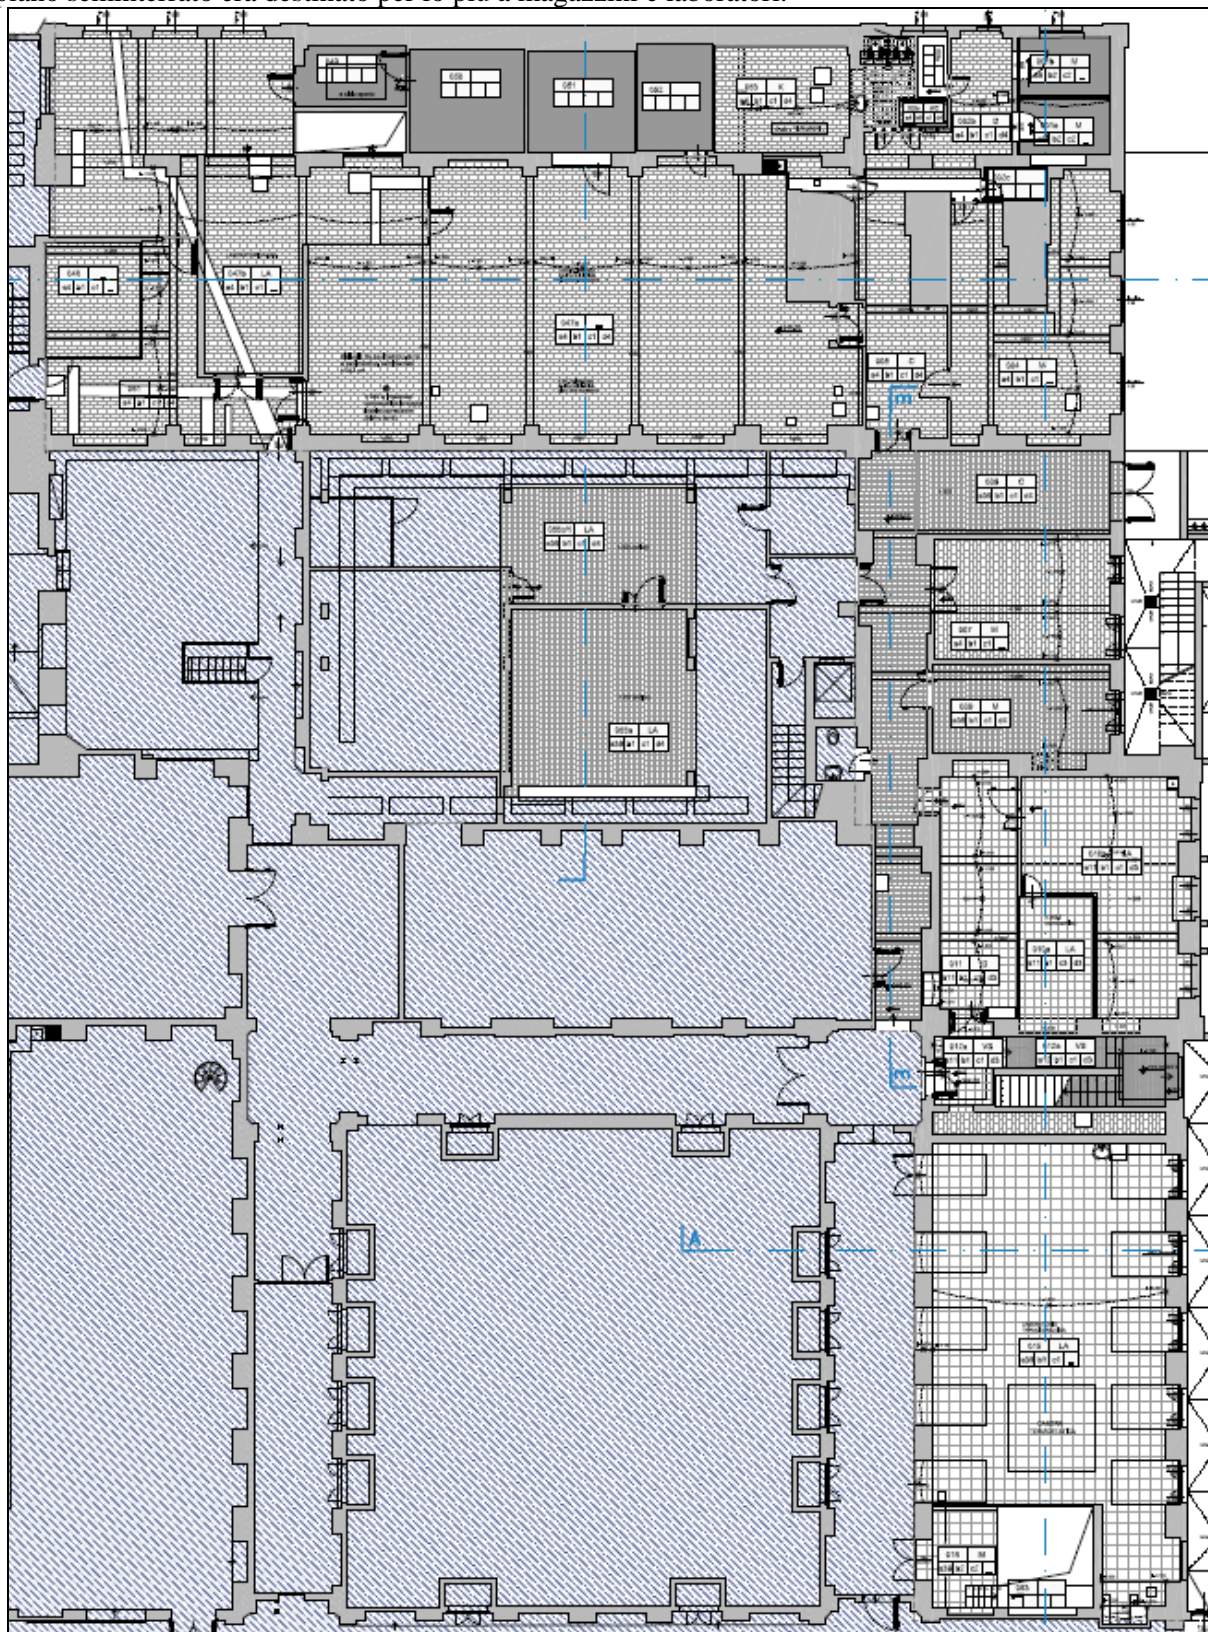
Pianta piano seminterrato – Lotto 1
